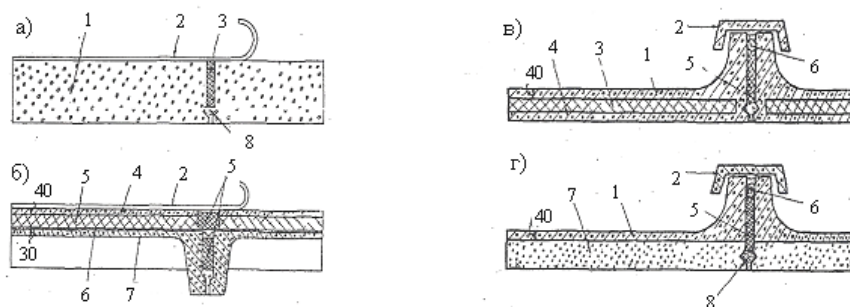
Конструктивное решение покрытий теплого чердака с рулонной (а,б) и с безрулонной (в,г) кровлей
